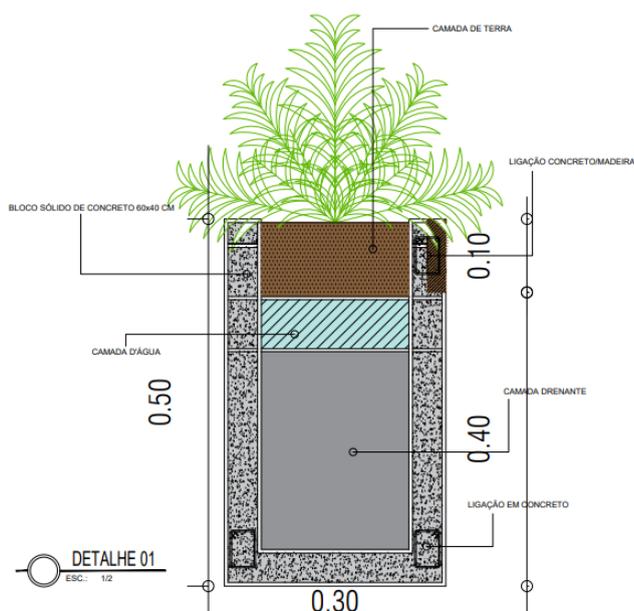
Planta Baixa e Vista de Mobiliário Urbano
